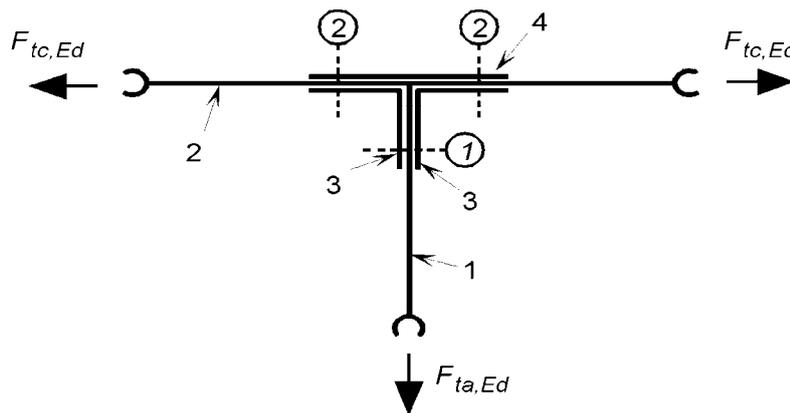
Geschraubte T-Verbindung mit Unterlegplatte
